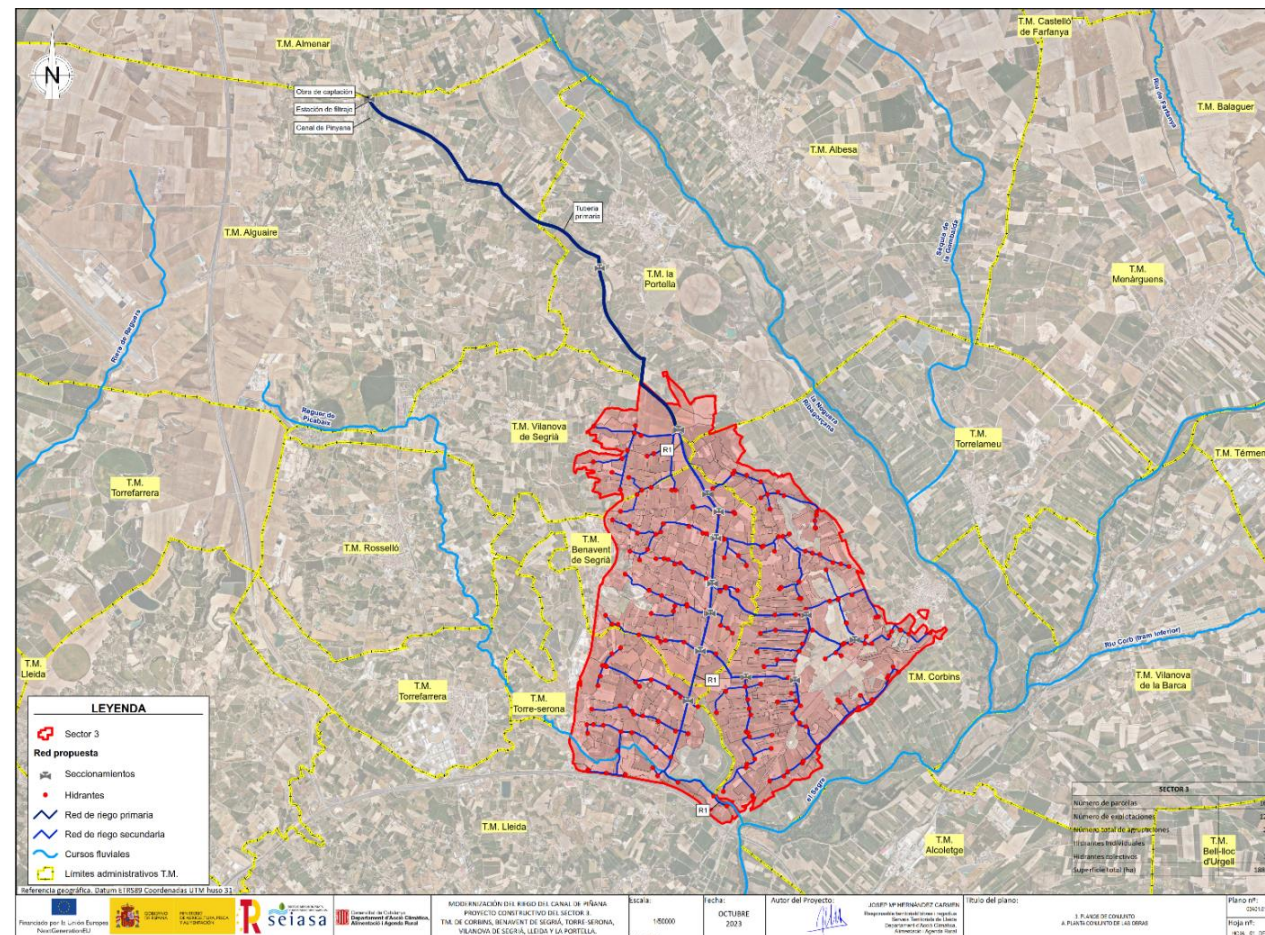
Planta general del conjunto de infraestructuras proyectadas.
